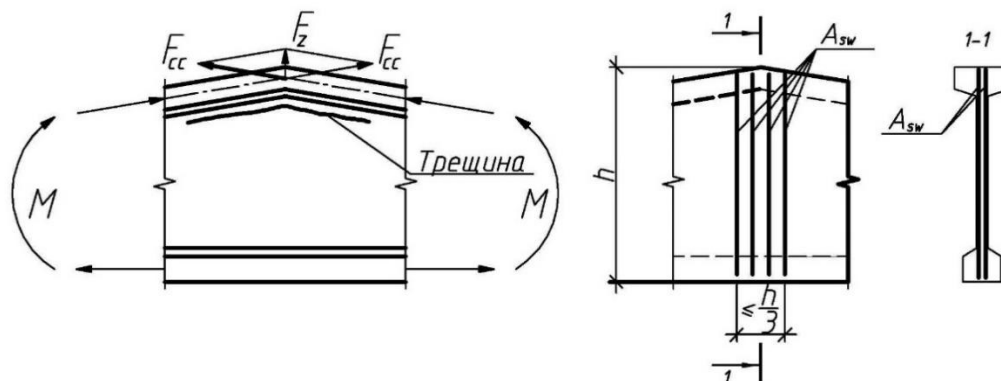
Схема образования трещин отрыва и армирование конька двускатной балки
